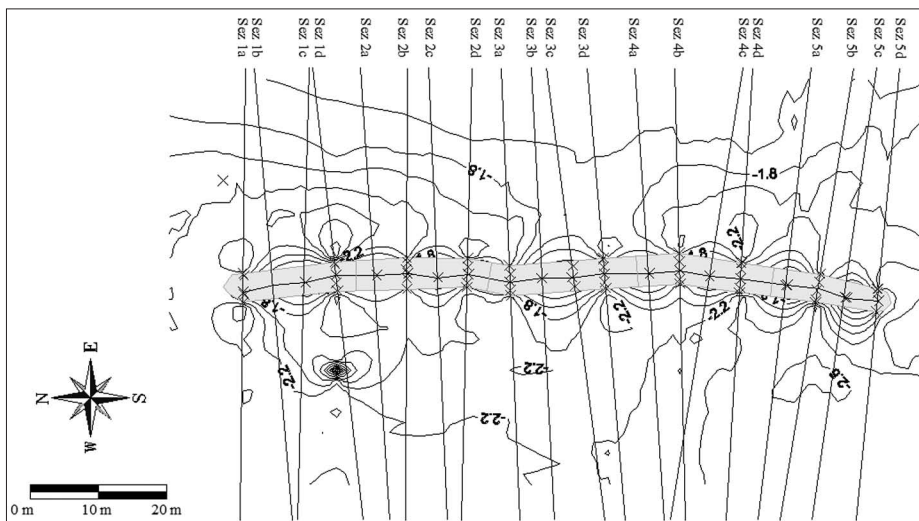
Posizionamento dei tubi e delle sezioni di rilievo (agosto 2008).
